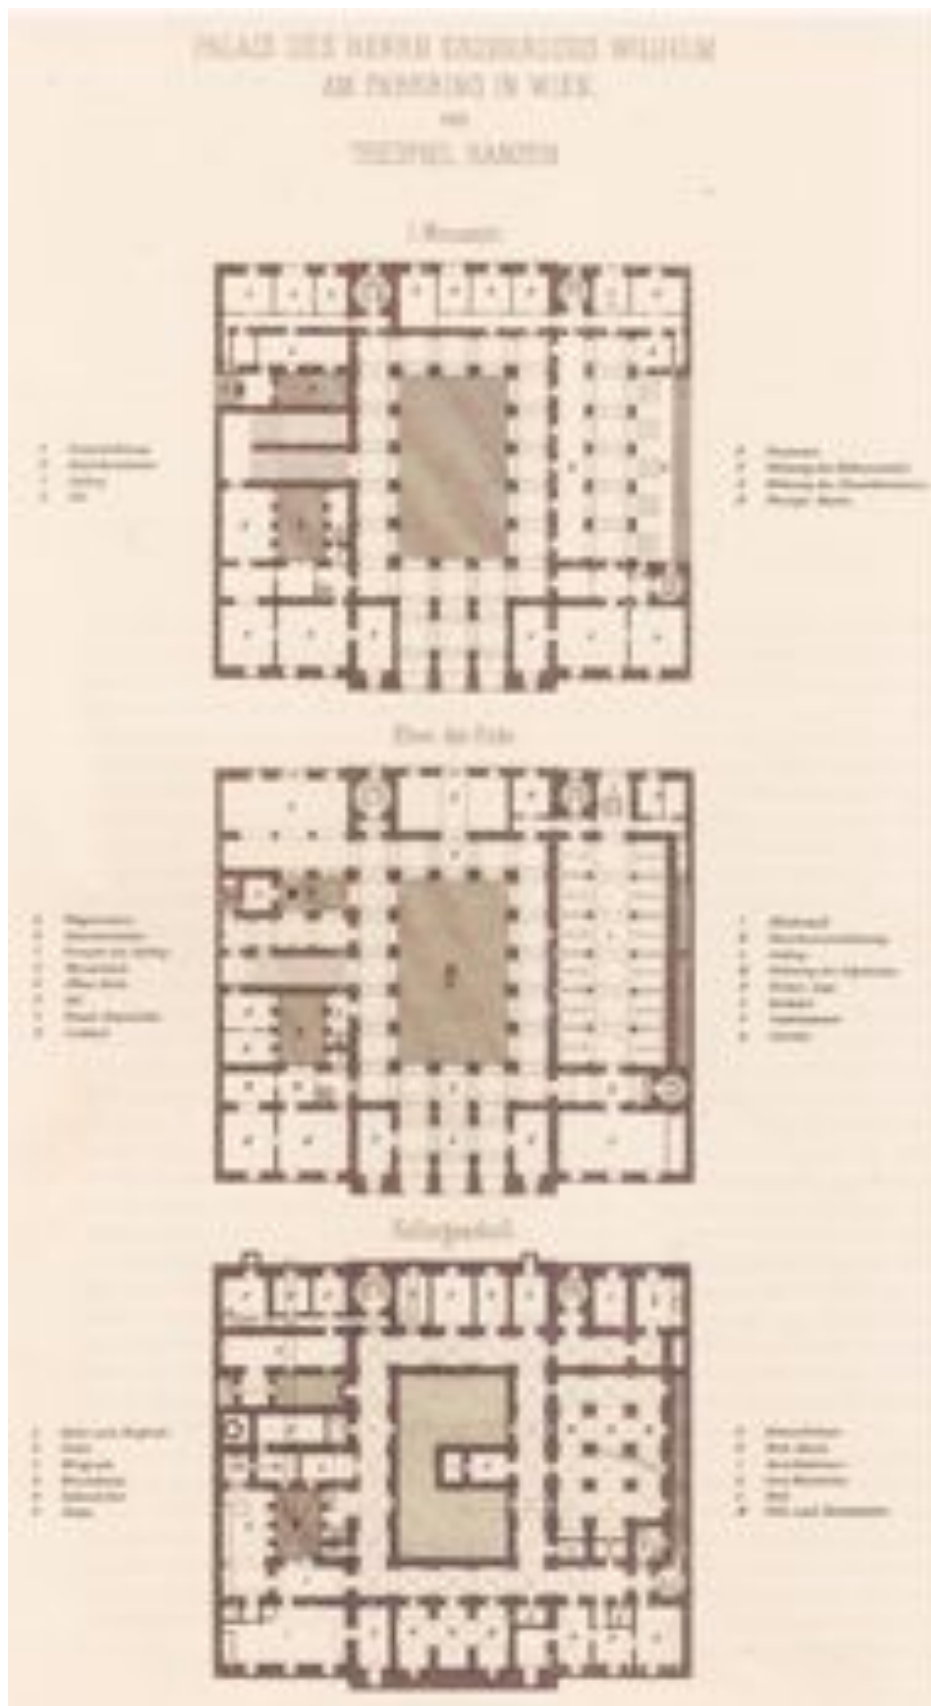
Hans Bütemeyer, Palais Erzherzog Wilhelm Grundrisse von 1. Mezzanin, Erdgeschoss und Keller, Stich, 1868.
